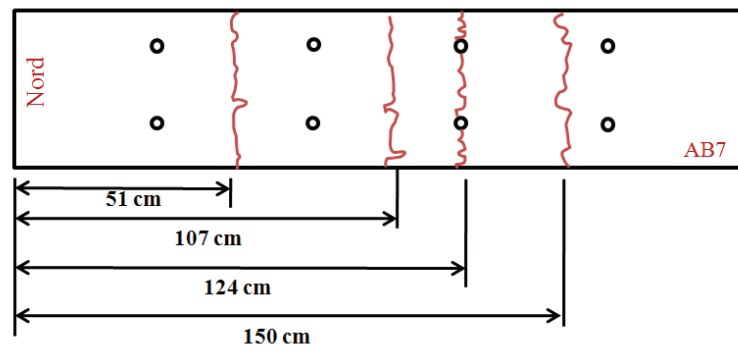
Relevé des fissures pour la poutre AB7
